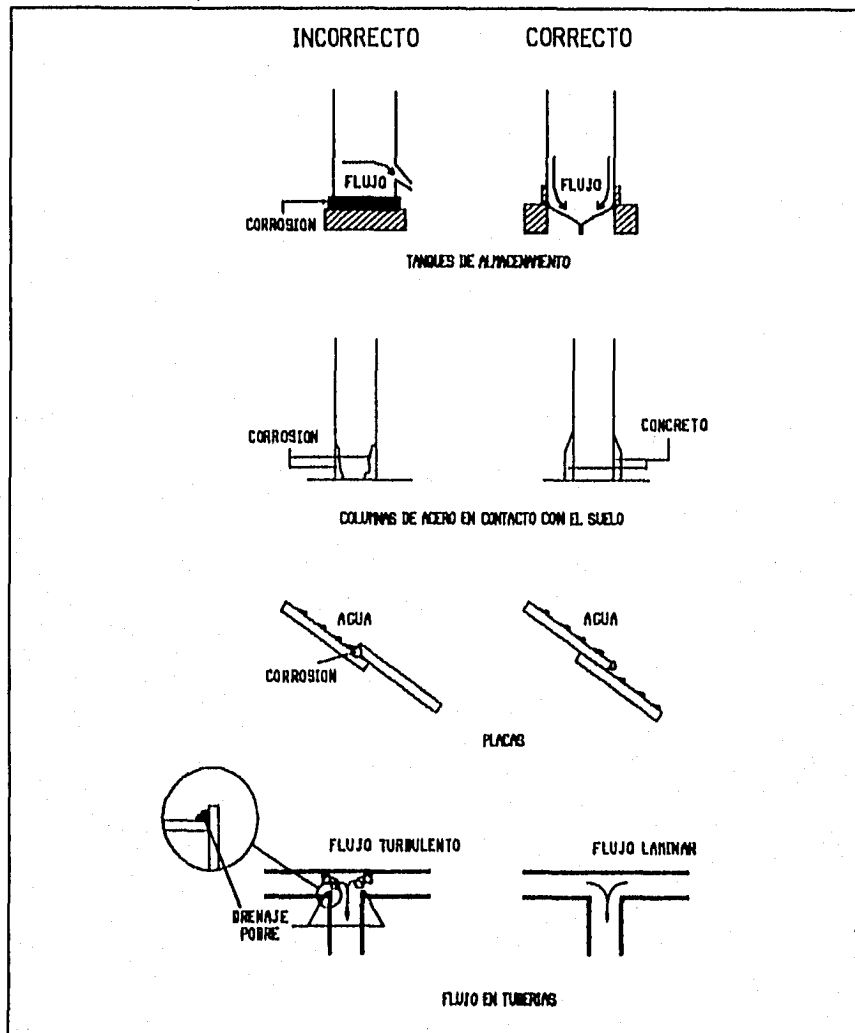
Diseños geométricos que ayudan a evitar la corrosión (25/29).
